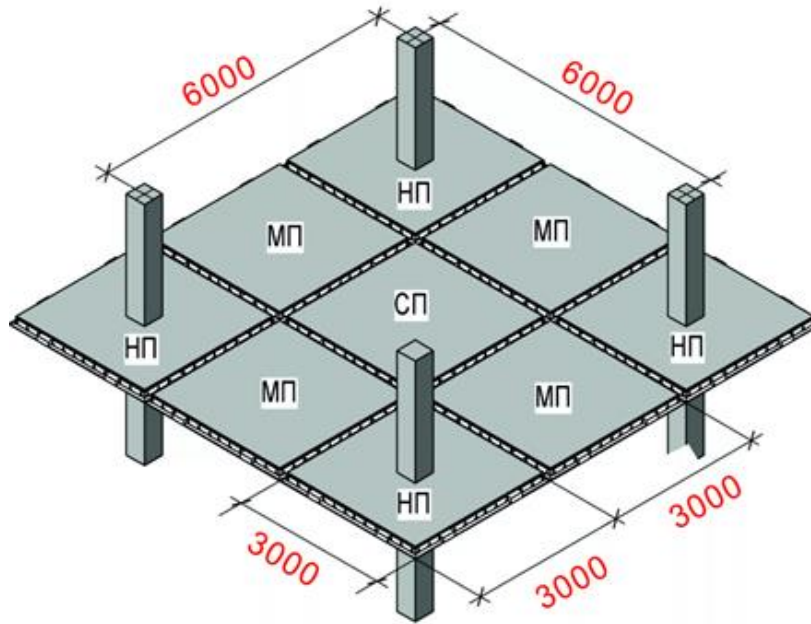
Диск перекрытия конструктивной системы «КУБ 2.5», типы плит и их расположение
